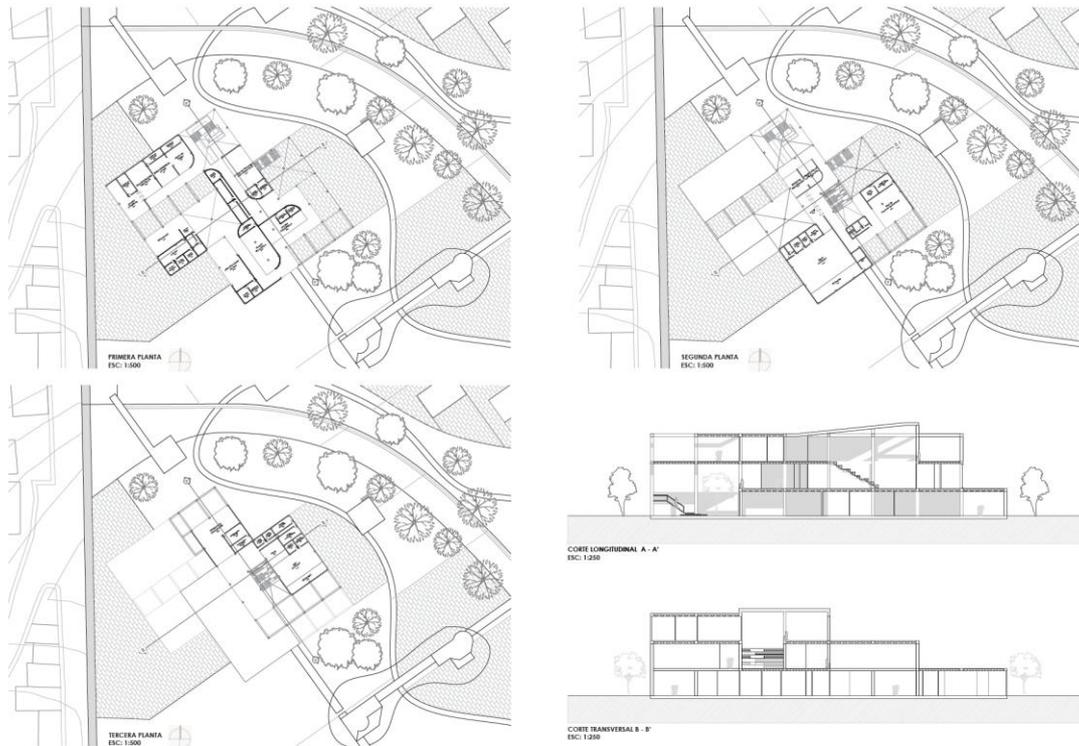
Planimetría segunda propuesta arquitectónica. Elaboración propia.
